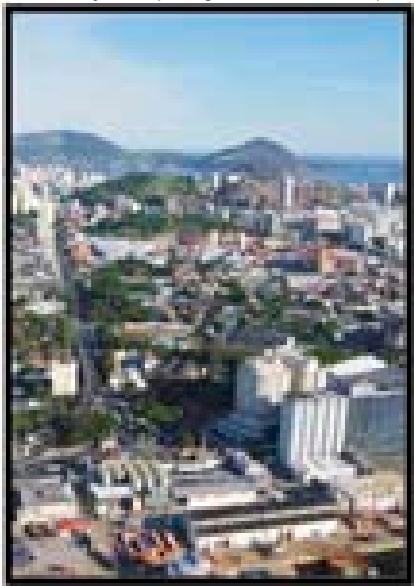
Vista parcial do local da passagem subterrânea da praça Renascença.
